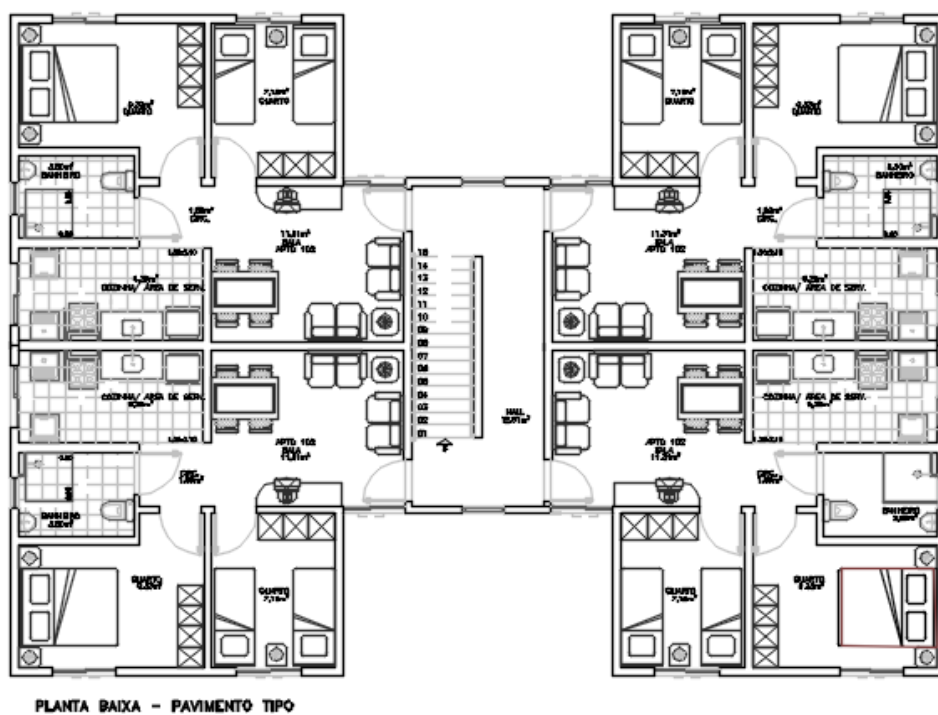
Planta do pavimento tipo do Empreendimento B.
